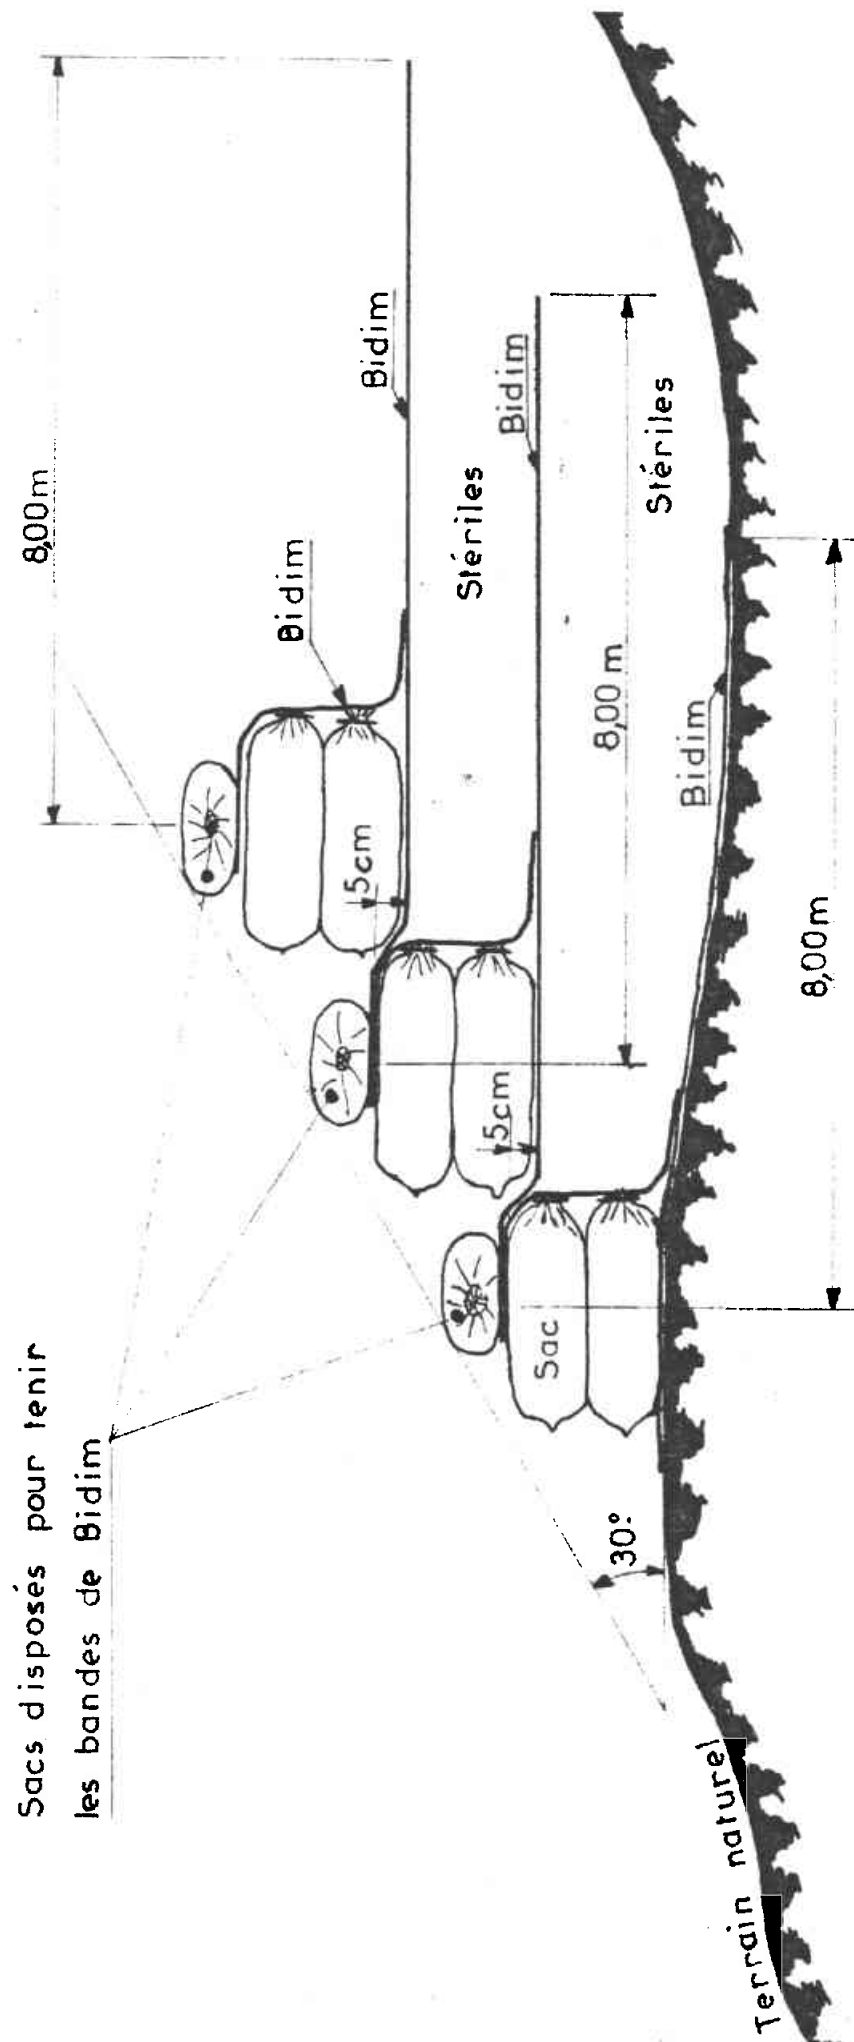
Principe de construction des digues de retenue des stériles de laverie (plan SMA)
